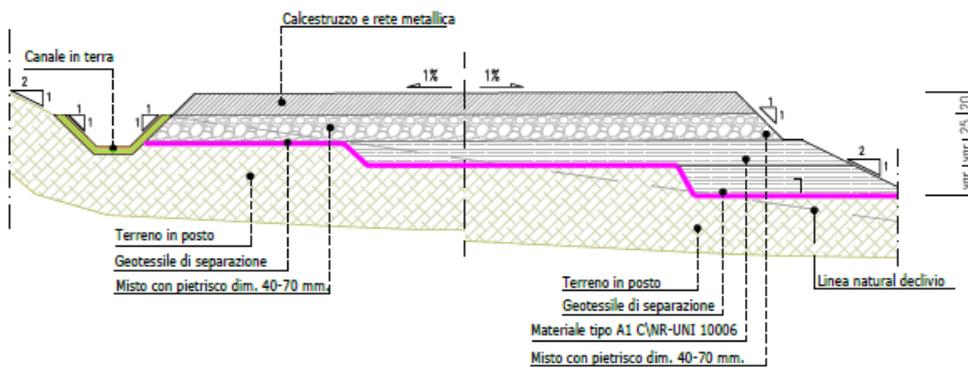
Sezione stradale tratti a mezza costa ( $p > 13\%$ )
